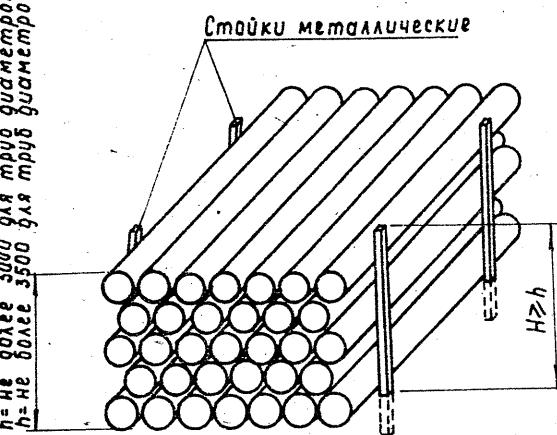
Складирование асбестоцементных труб в штабелях на выровненной площадке.
